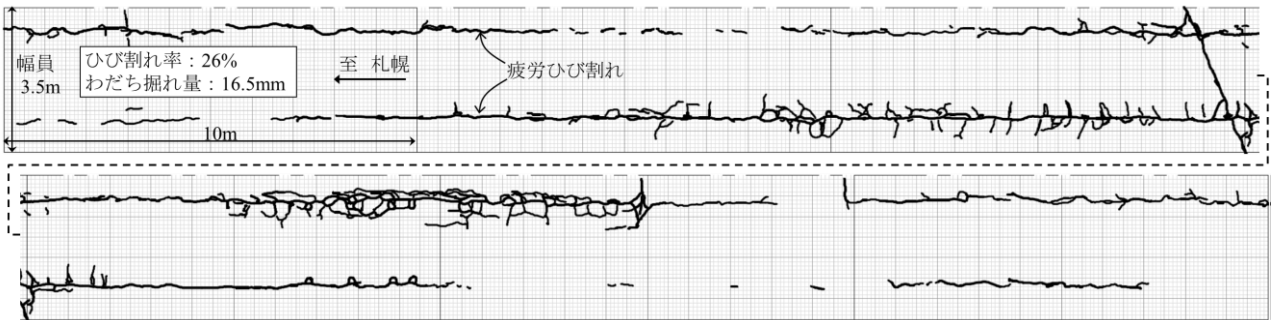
補修前の路面の疲労ひび割れ状況(幅員3.5m、延長60m区間)
